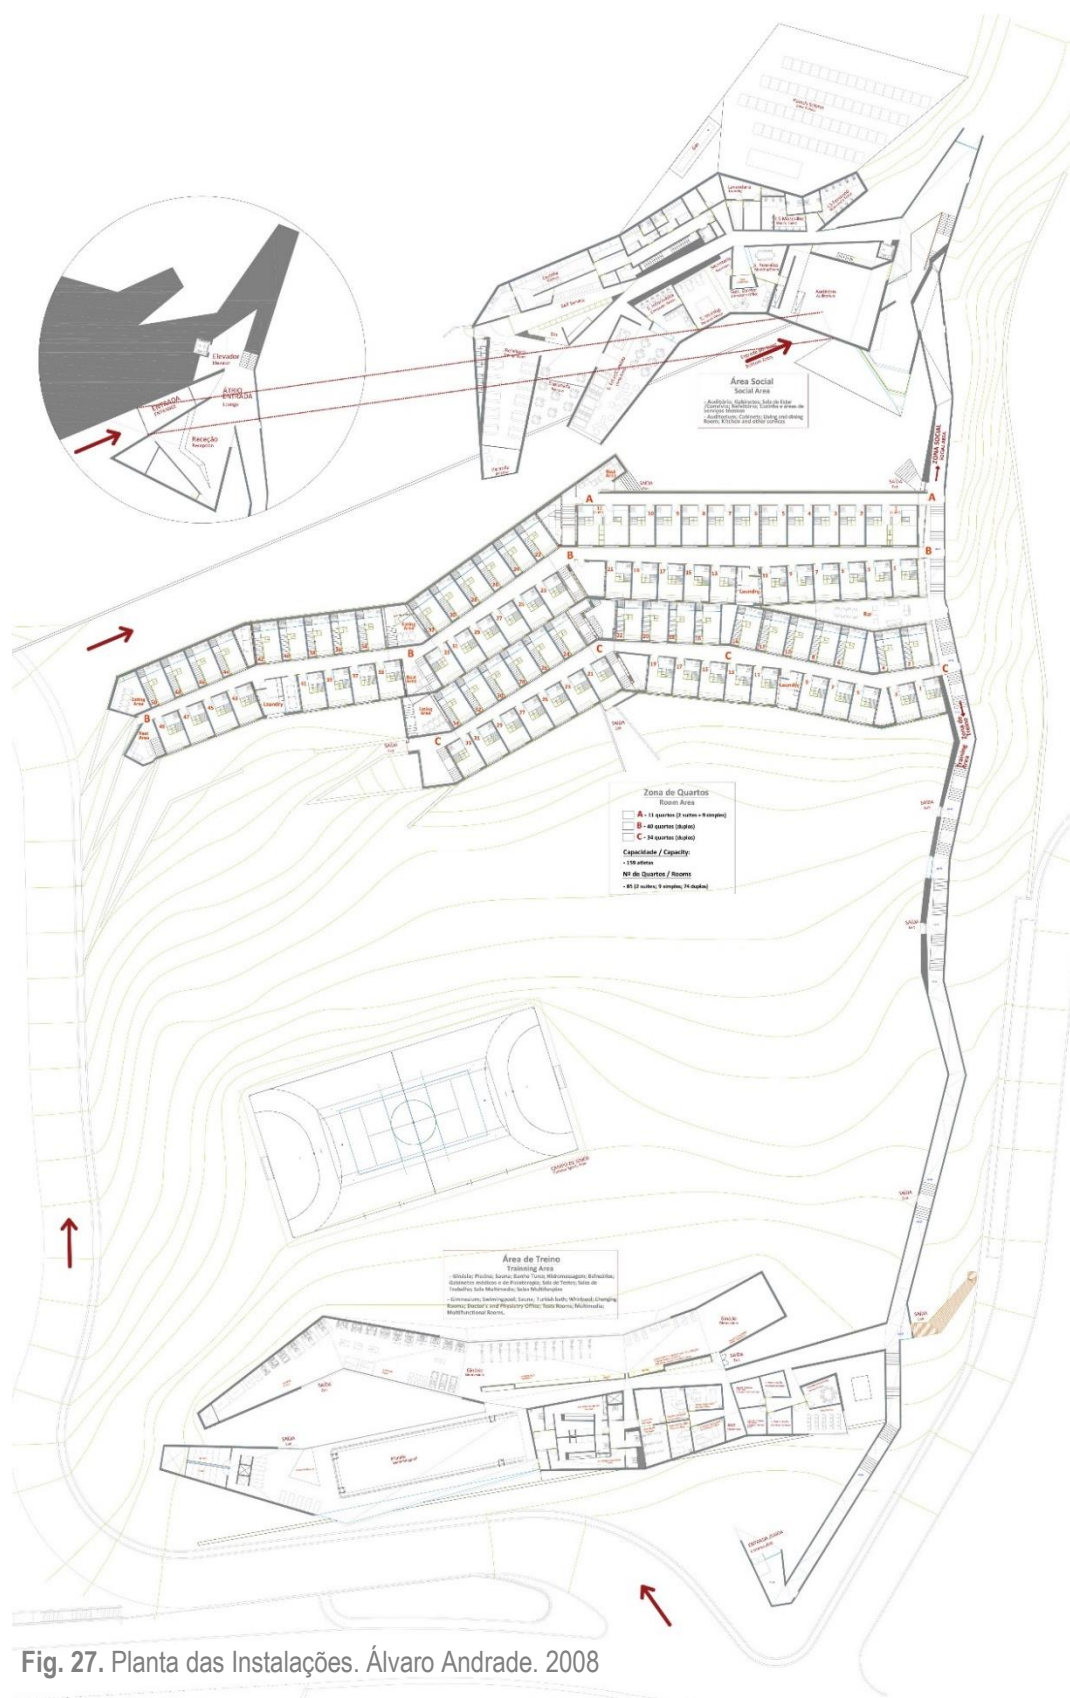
Planta das Instalações. Álvaro Andrade. 2008
